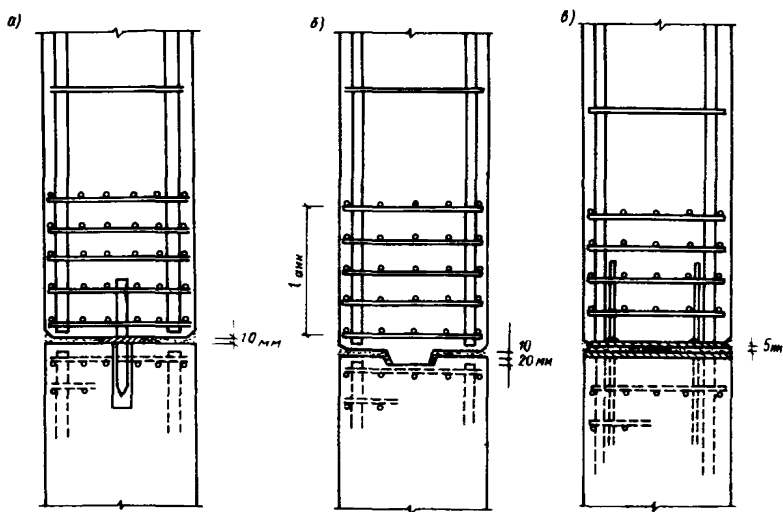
Армирование контактных стыков с полным обрывом продольной арматуры
